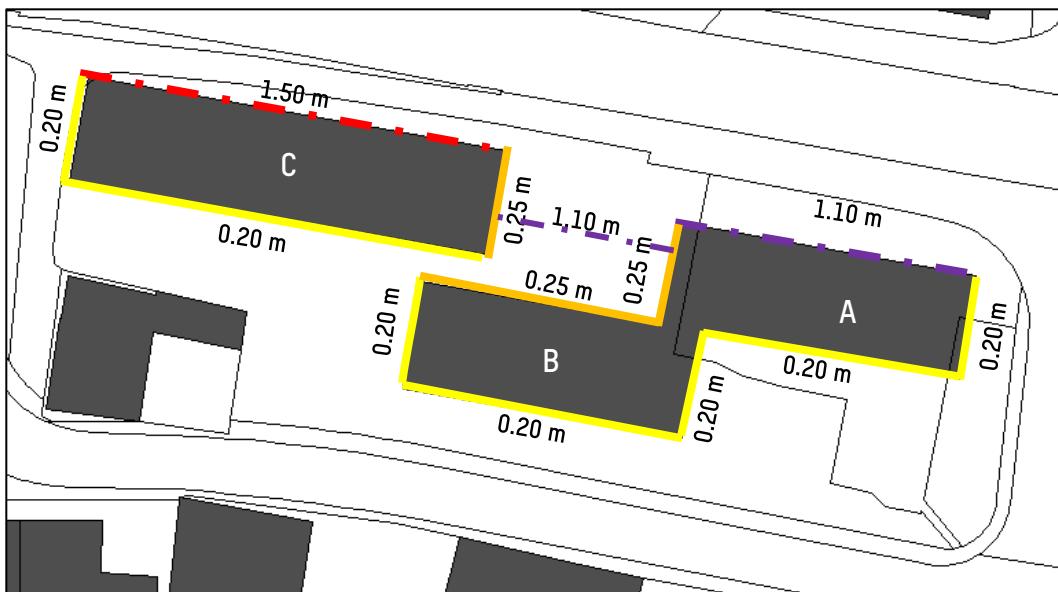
Grundriss Gebäude A-C mit Einwirkhöhen an der Fassade, basierend auf projektierten Terrainverhältnissen (DTM 2021, in Modellierung modifiziert [1]).
